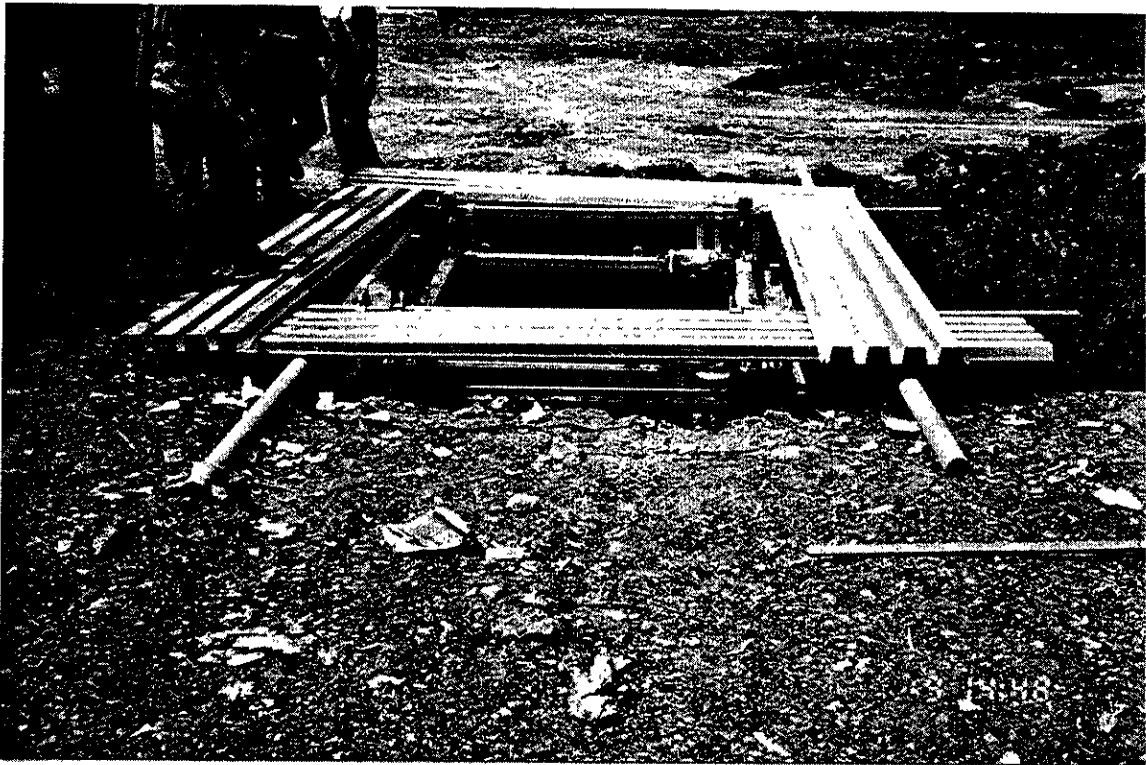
Dépôt du VM2 en fonds de puits (a)
